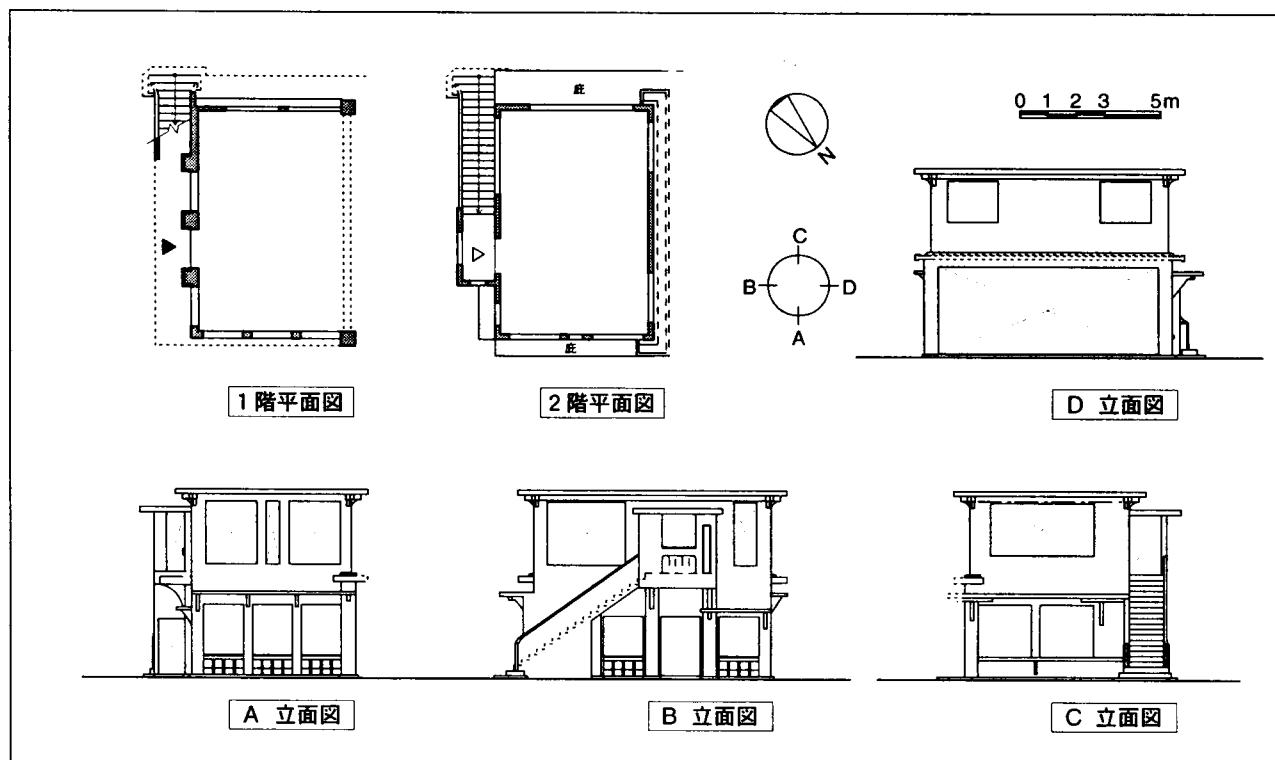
旧南洋興発テニアン製糖所工場糖度分析所の現況平面図と立面図
